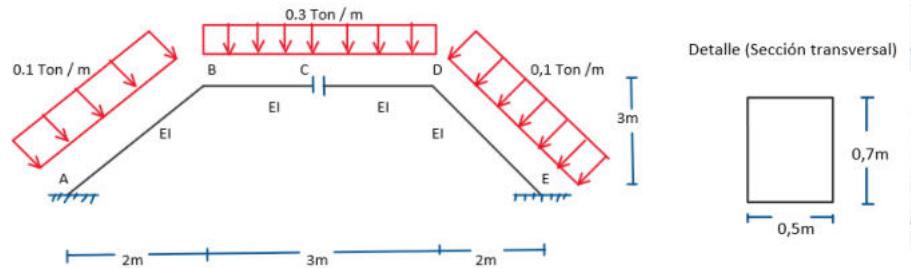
Idealización estructural simétrica con biela interna y vigas inclinadas.
